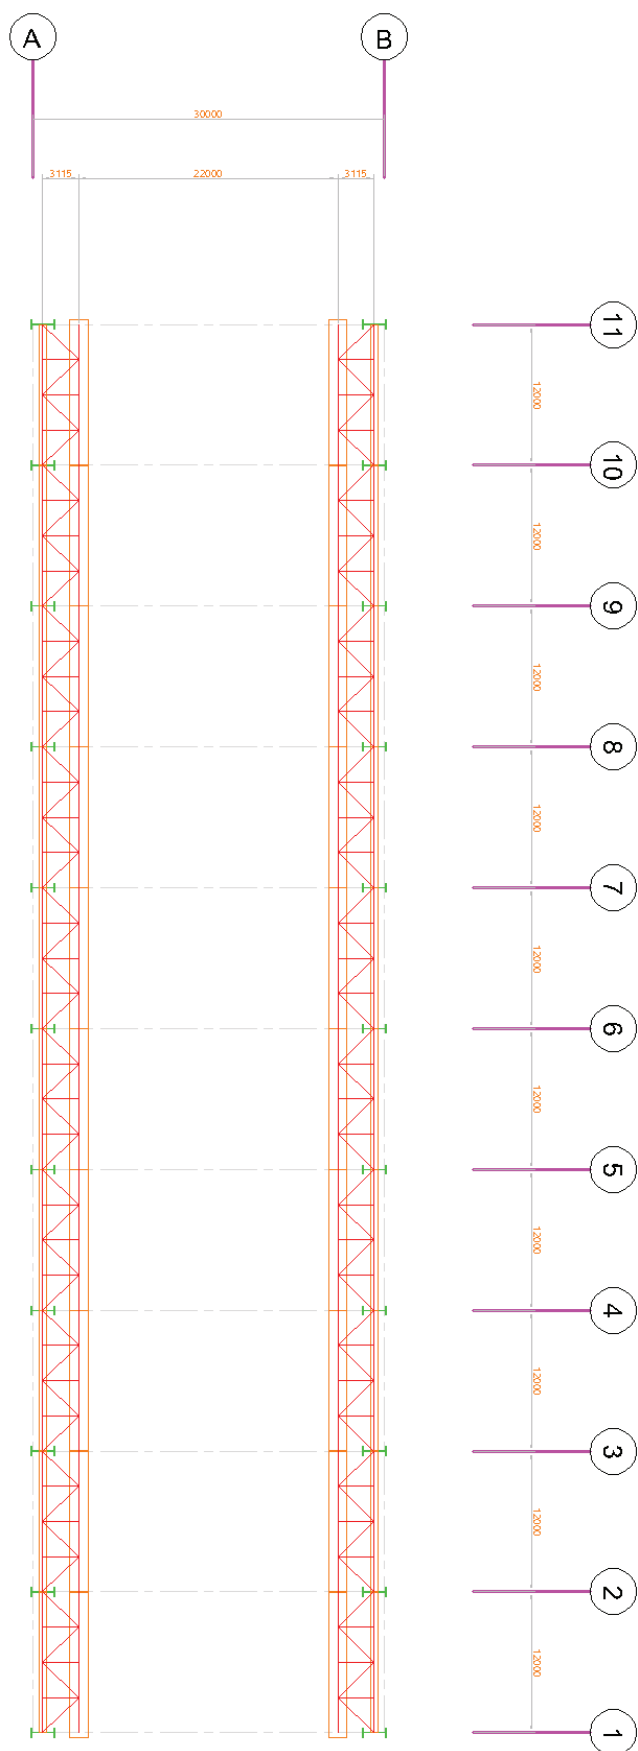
Planta da viga de rolamento, El + 44,000 m.
